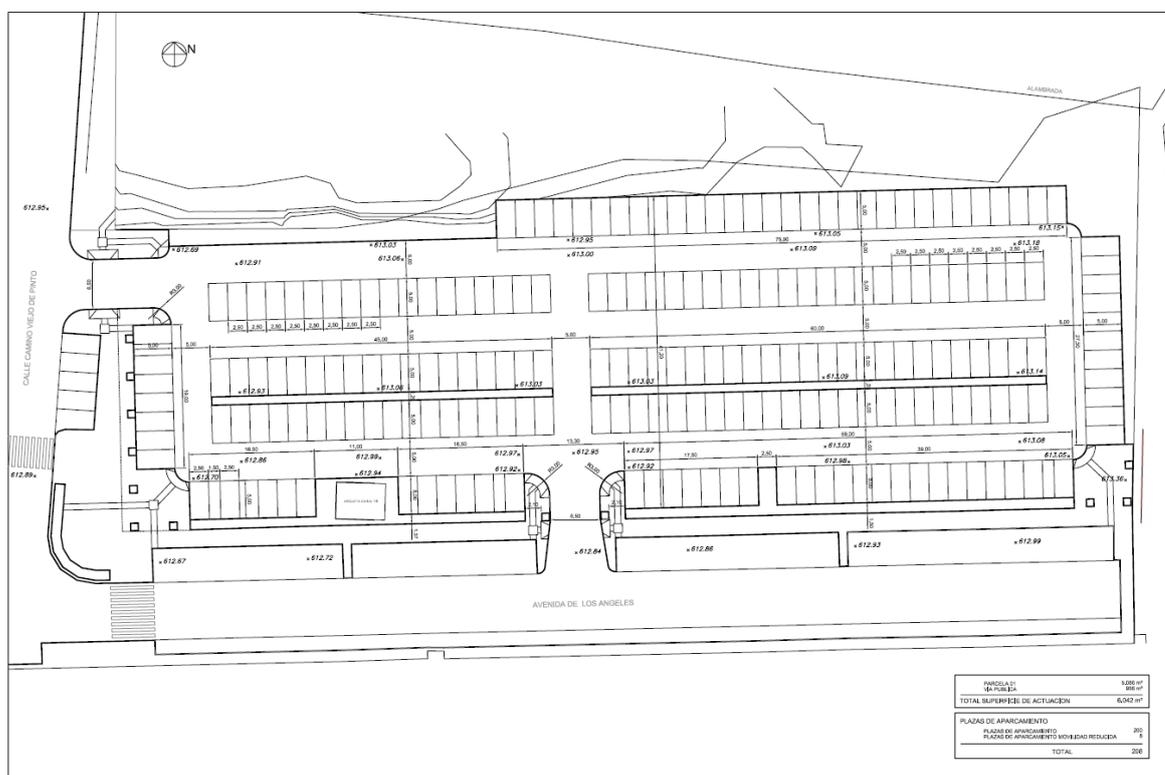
Plano de replanteo del área de aparcamiento provisional (octubre 2016)
